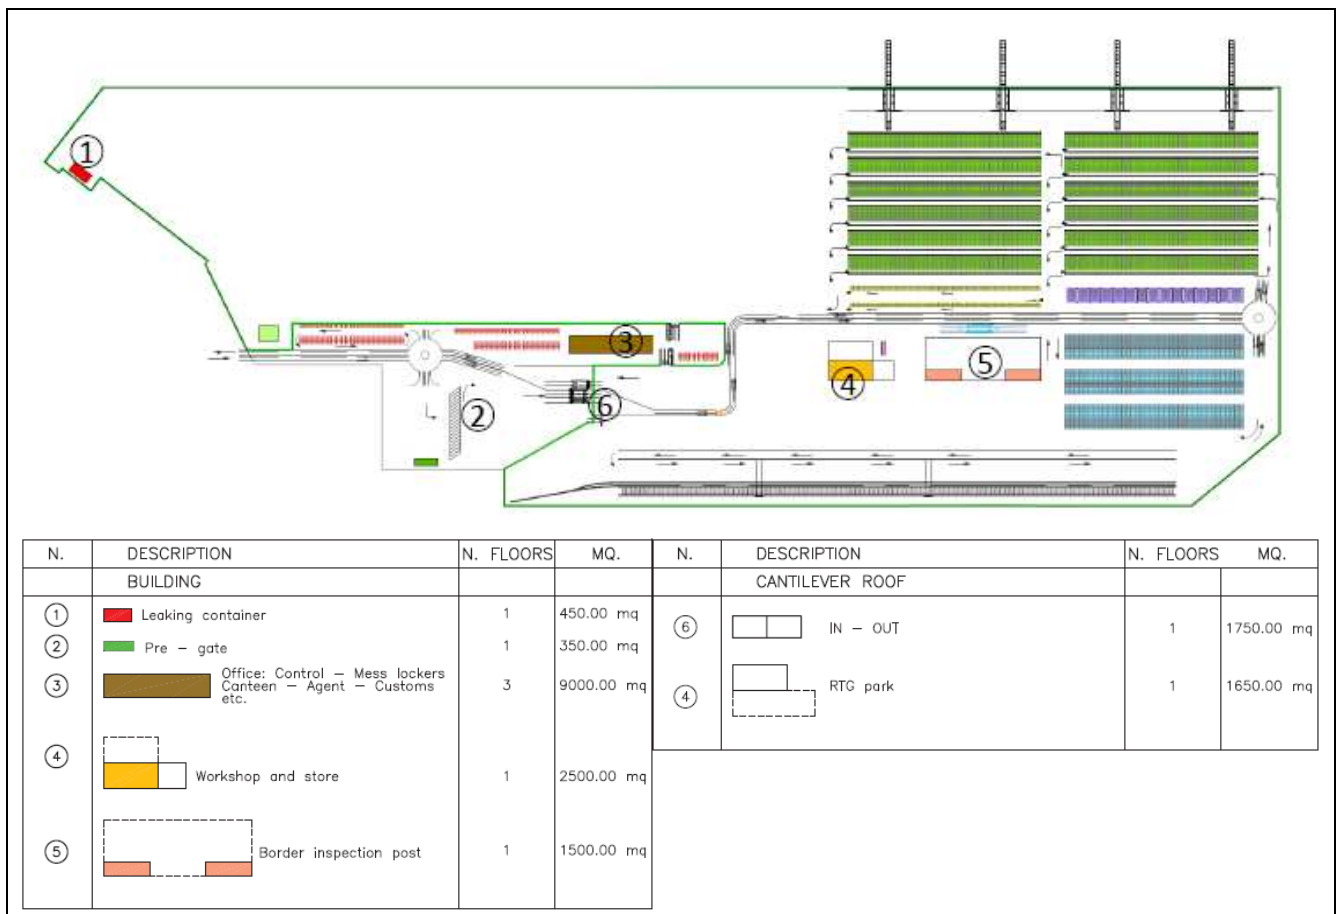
Planimetria terminal convenzionale e indicazione strutture principali
